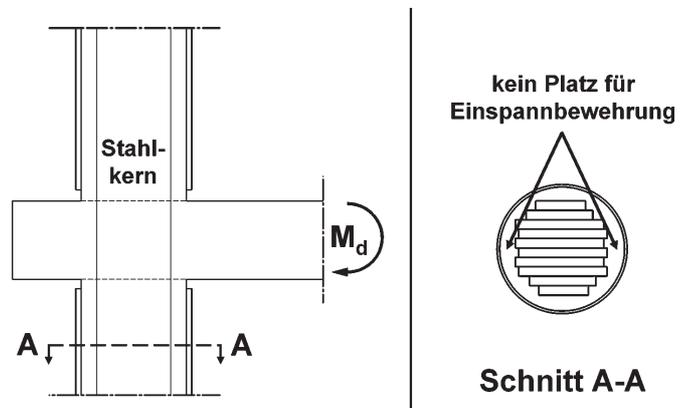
Verbundrandstütze mit kleiner Betonnettoquerschnittsfläche
